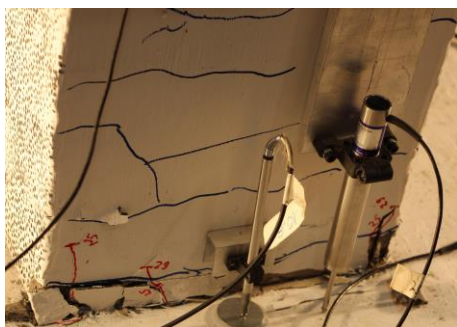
Fissures verticales de compression sur la face latérale droite de la colonne C1A au LS31
